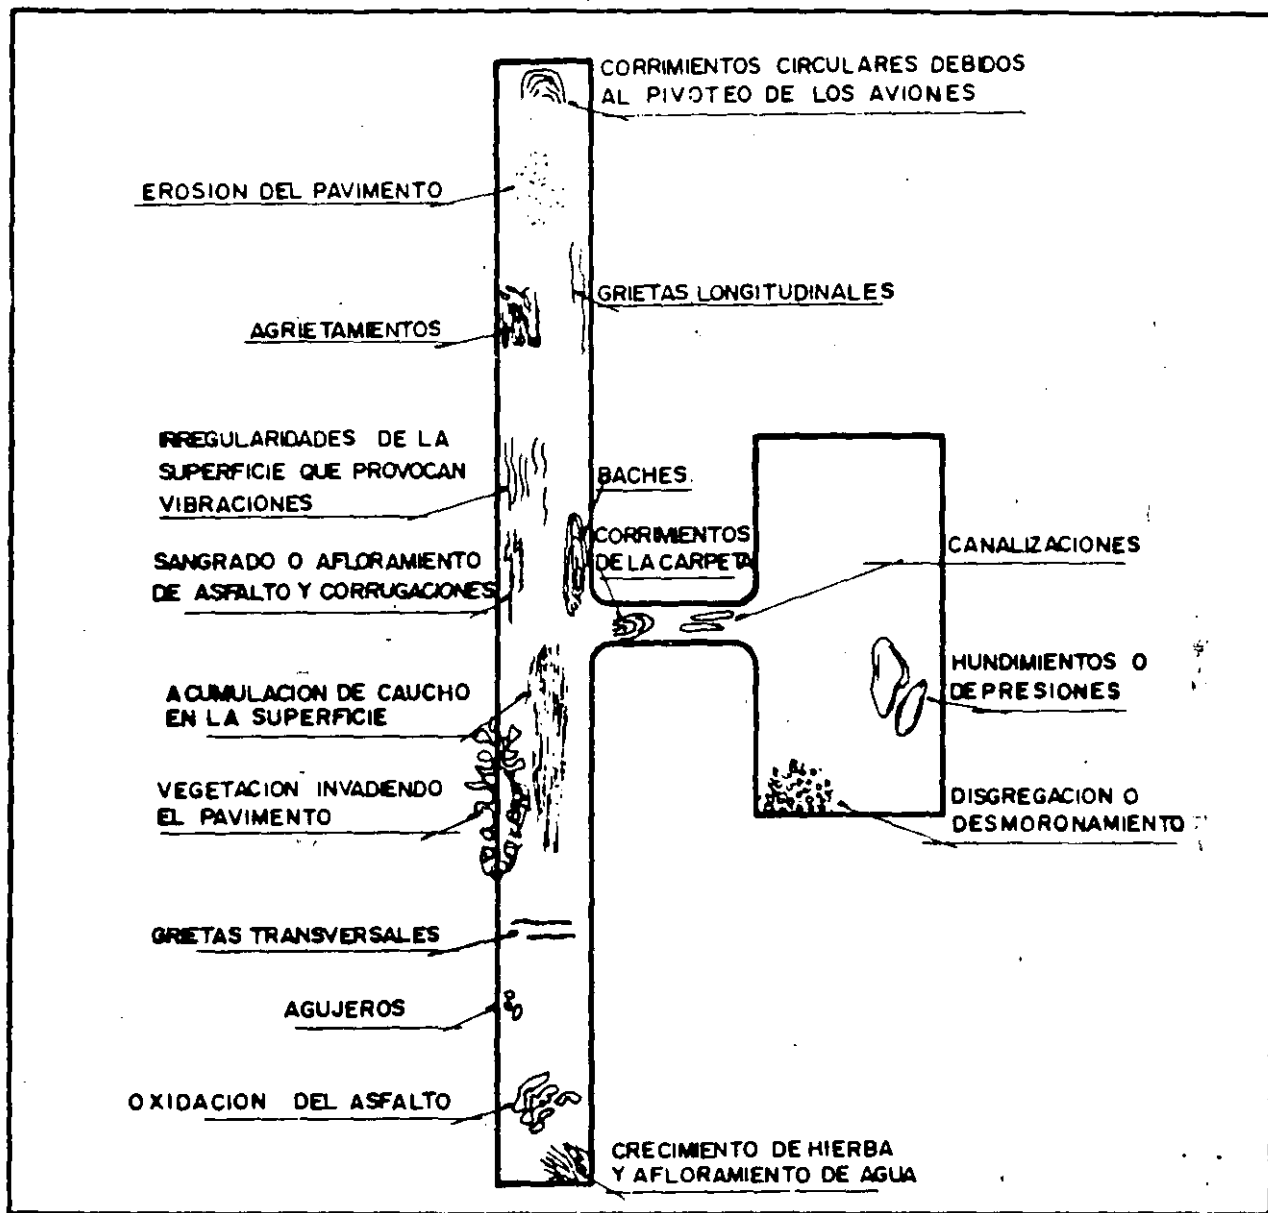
Conservación y detalles a observar en pavimentos flexibles
